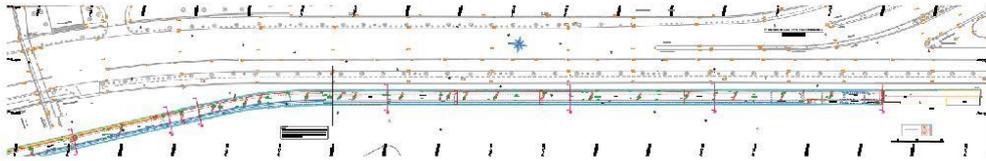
EXTRAIT PLAN TOPOGRAPHIQUE DE LA GALERIE SNCF
